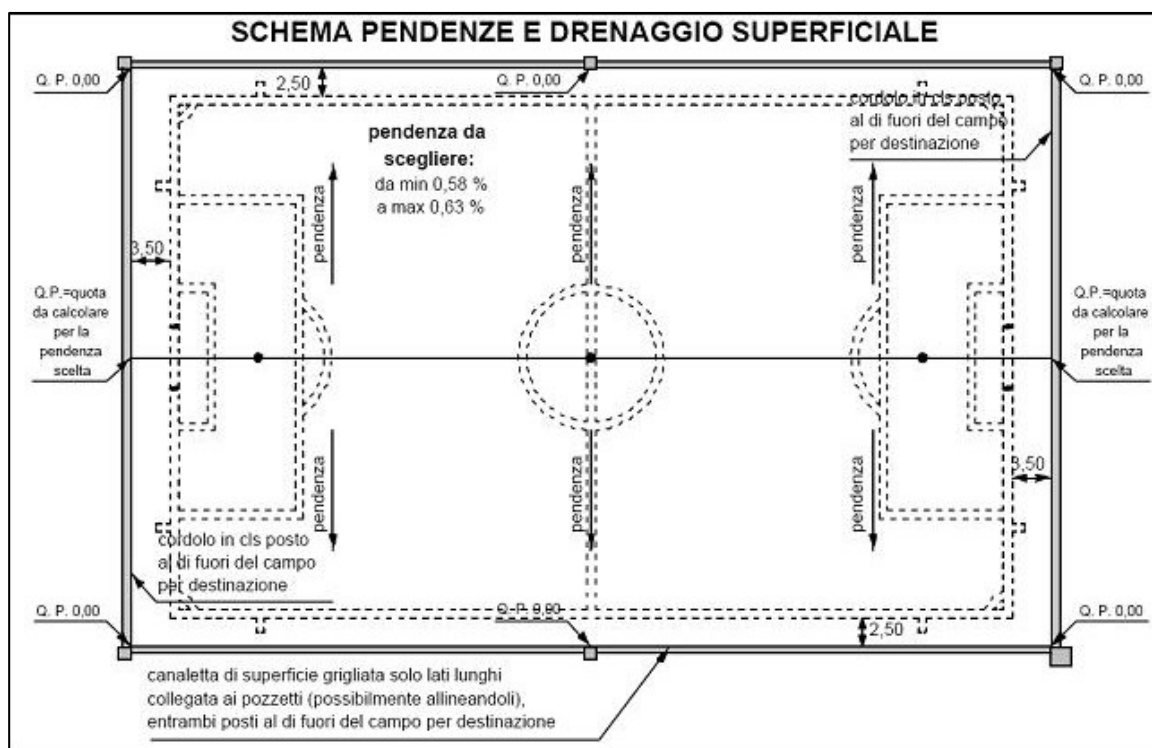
Planimetria schema tipo pendenze a drenaggio superficiale
